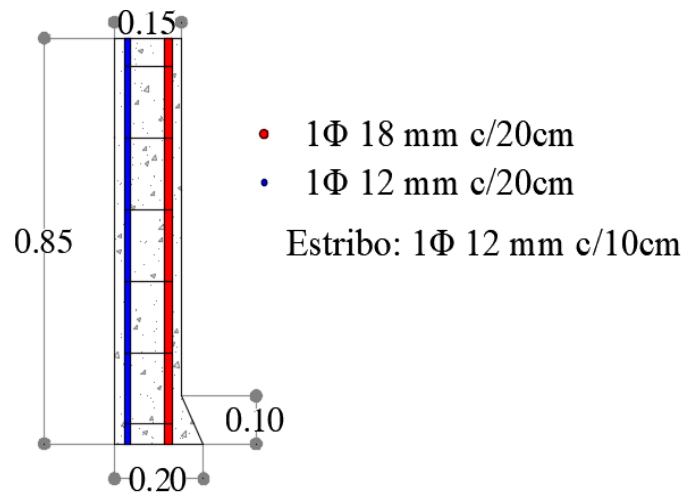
Armado del parapeto, análisis en sentido transversal (vista frontal)
